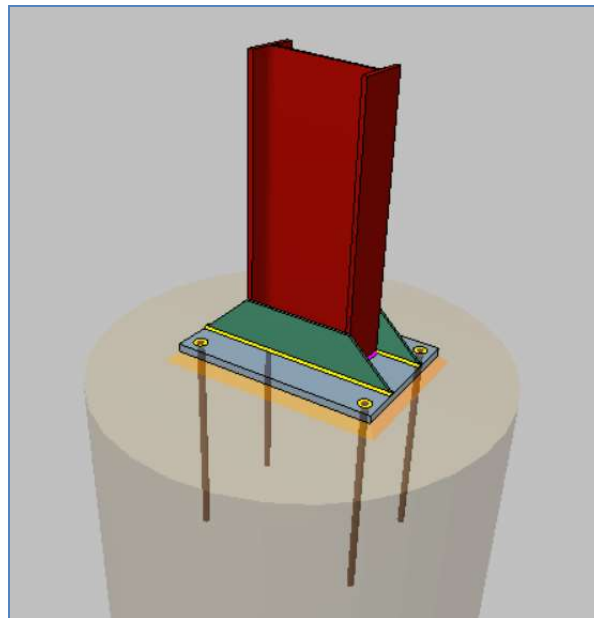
detalle pilar junto a placa de anclaje y pernos
